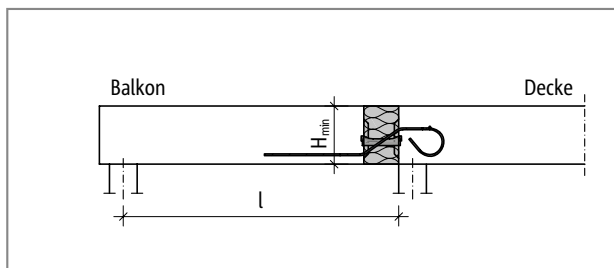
Schöck Isokorb® Typ QXT: Statisches System (Typ QXT10 bis QXT40)
